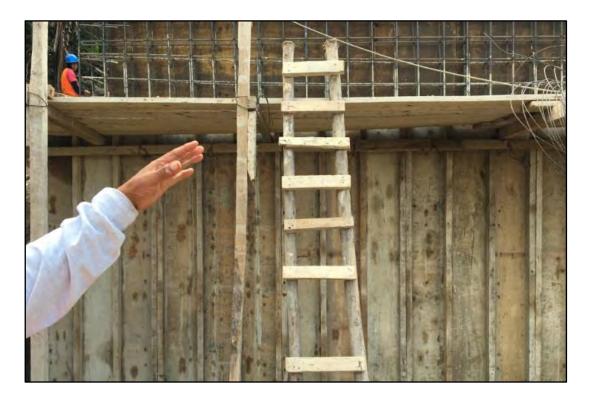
Encofrado segundo cuerpo tanque Imhoff. Fuente: Elaboración propia
